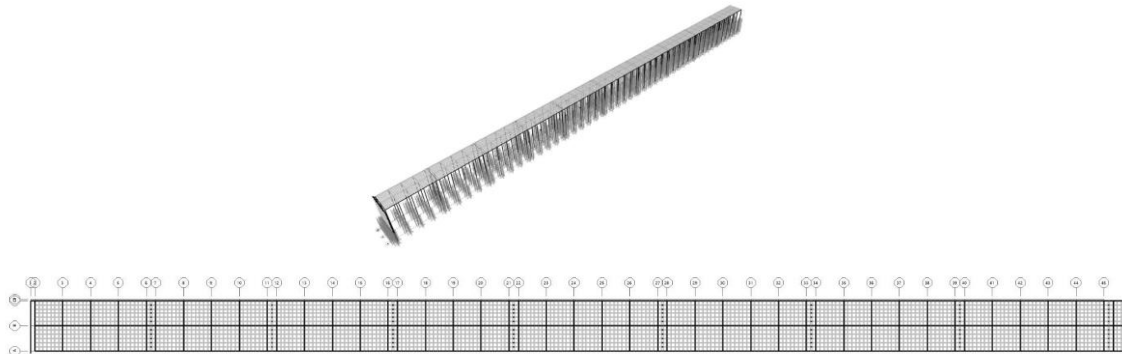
Modelo estrutural da Ponte-cais – Vista 3D e Planta.
